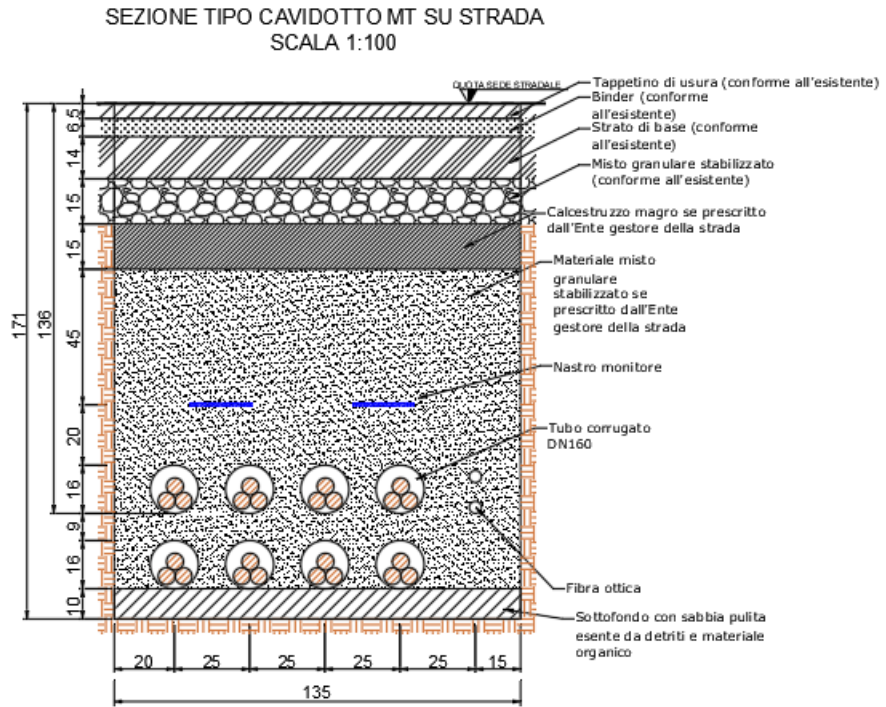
Tipologico sezione cavidotto MT su strada
